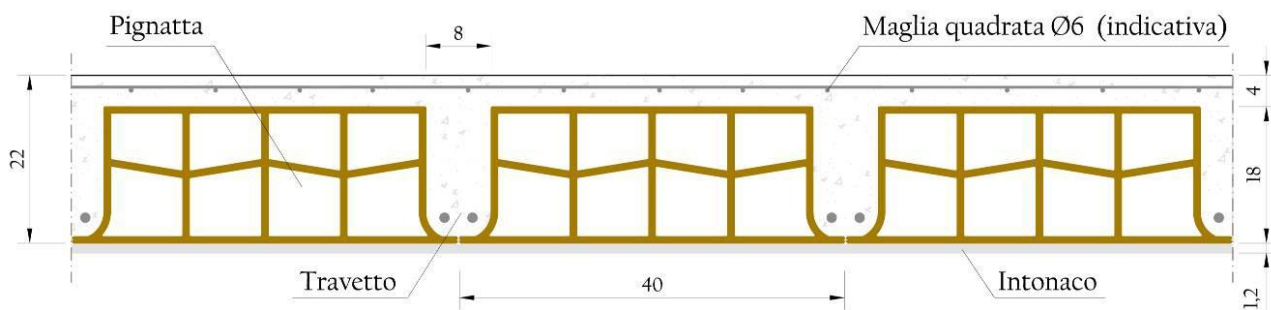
Dettaglio del solaio latero-cementizio con pignatte
